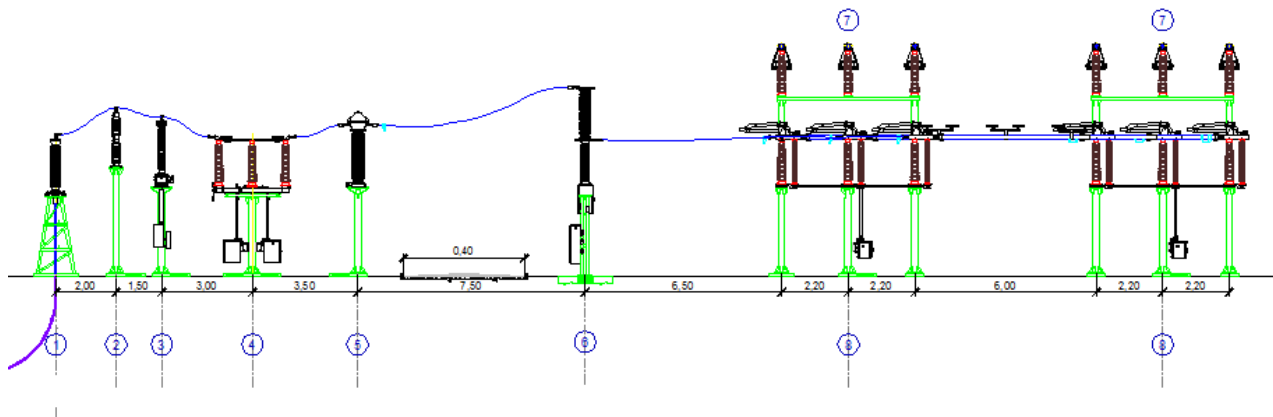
sezione futuro stallo 150 kV di arrivo in Stazione Elettrica RTN
